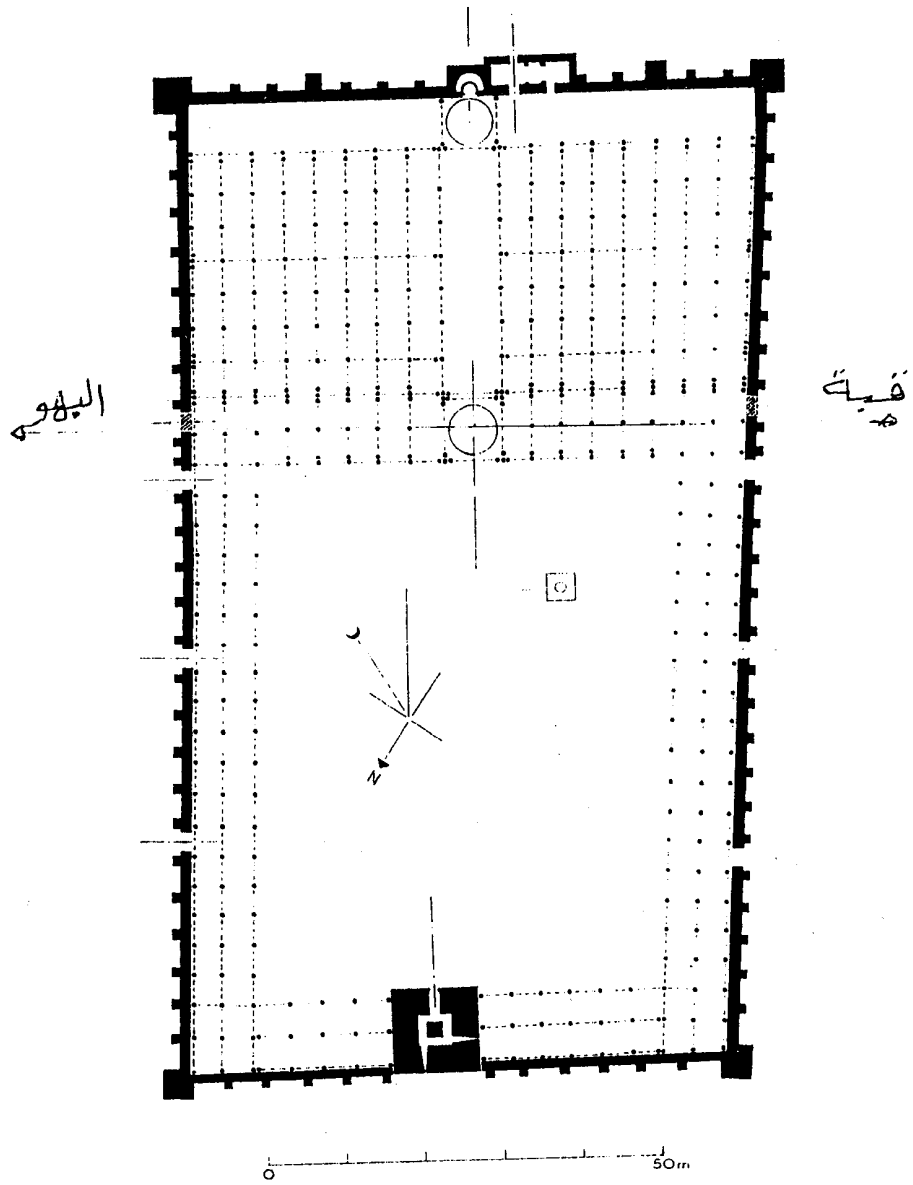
مسقط أفقي للجامع الاموي بدمشق (عن : Wulzinger nud Watuzinger)
